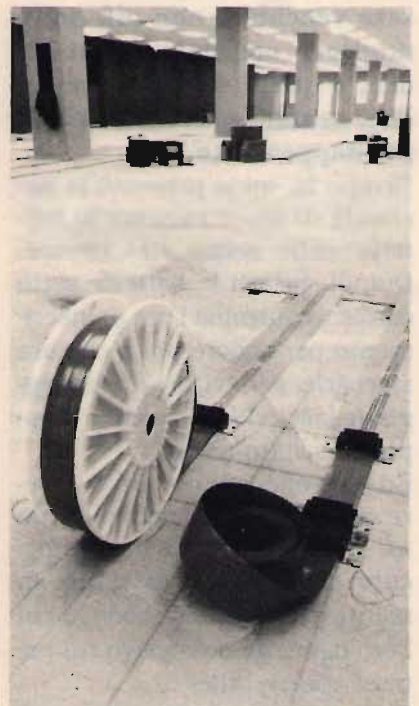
Installazione dei cavi a fibra ottica sotto la pavimentazione di un open-space per uffici.
